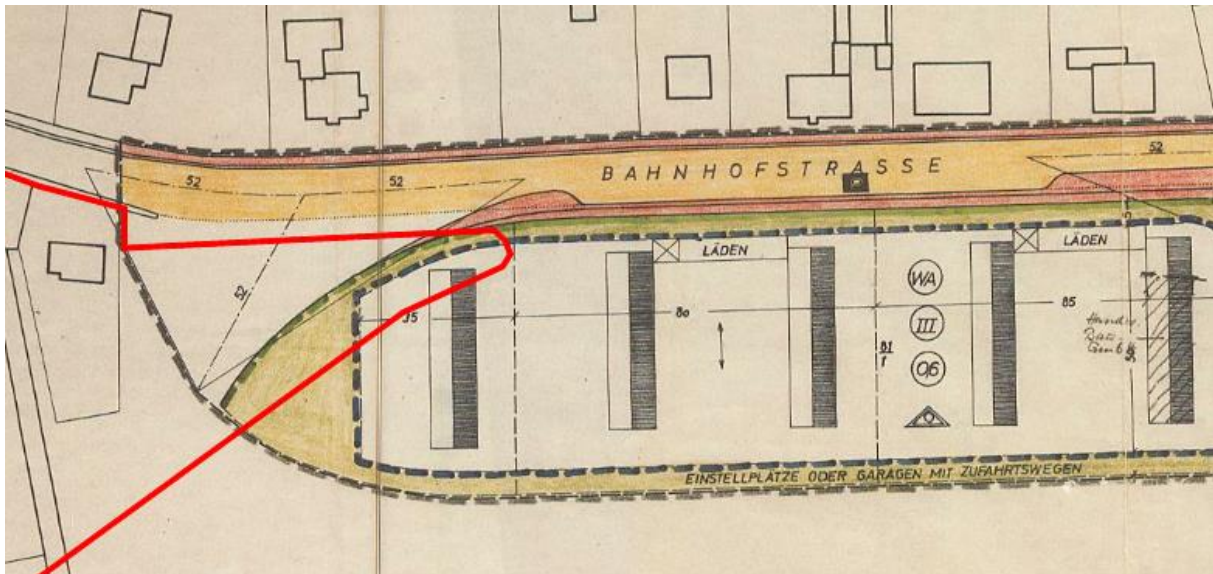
Ausschnitt aus dem B-Plan Nr.5, nicht genordet, Geltungsbereich B-Plan Nr. 56 rot umrandet, ohne Maßstab
